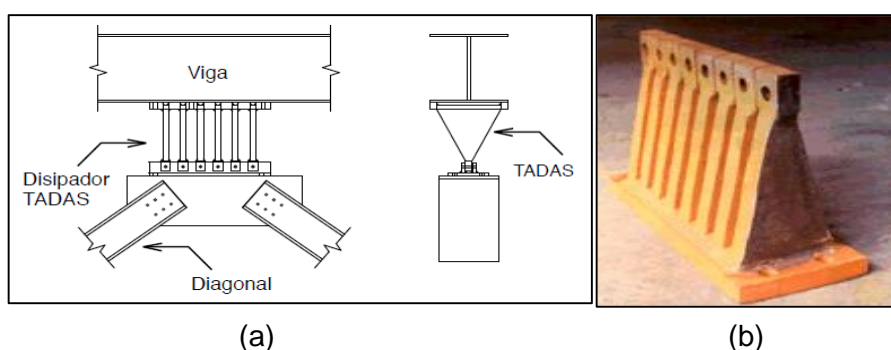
(a) Esquema de la aplicación dispositivo histerético tipo (TADAS), (b) Dispositivo histerético tipo TADAS (Fuente (a) cámara chilena de la construcción, 2011: Protección sísmica de estructuras, (b) Tsai et al., 1993) (Tsai et al, 1993)
